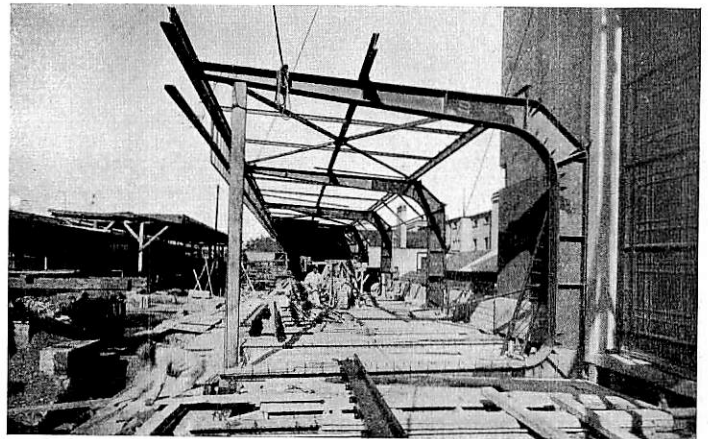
Bahnsteigdach I, elektrisch geschweißte Binder.
